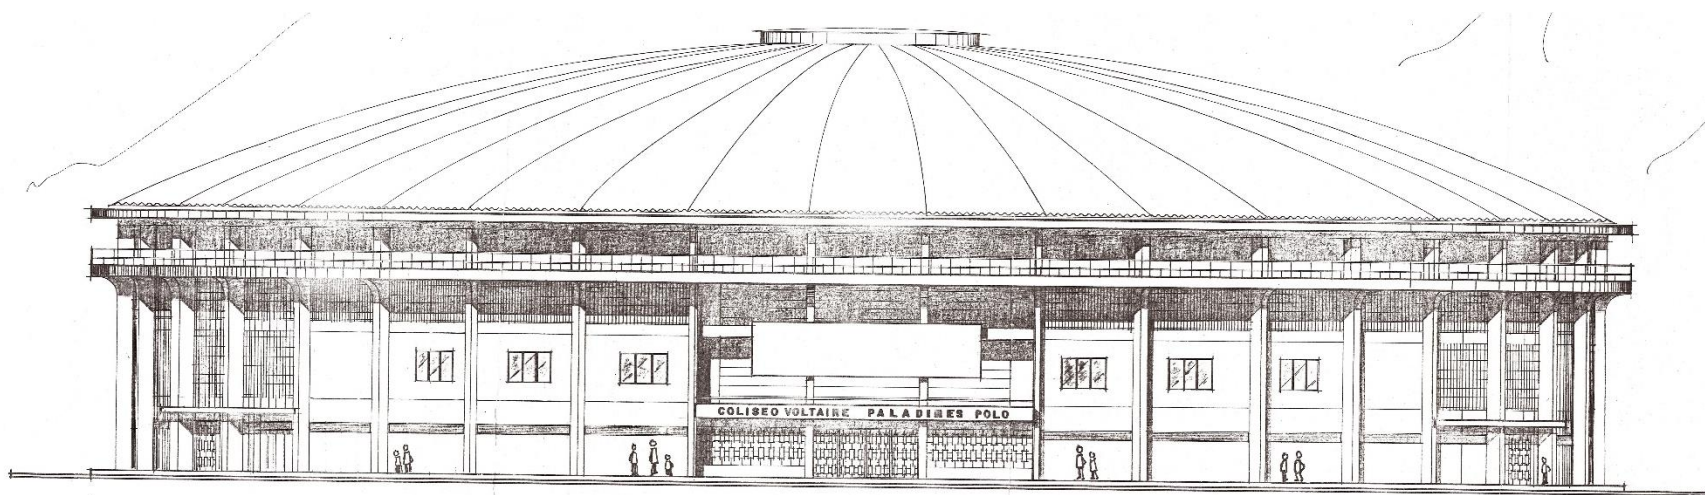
Fachada este existente. Fuente: Federación Deportiva del Guayas (2018).
